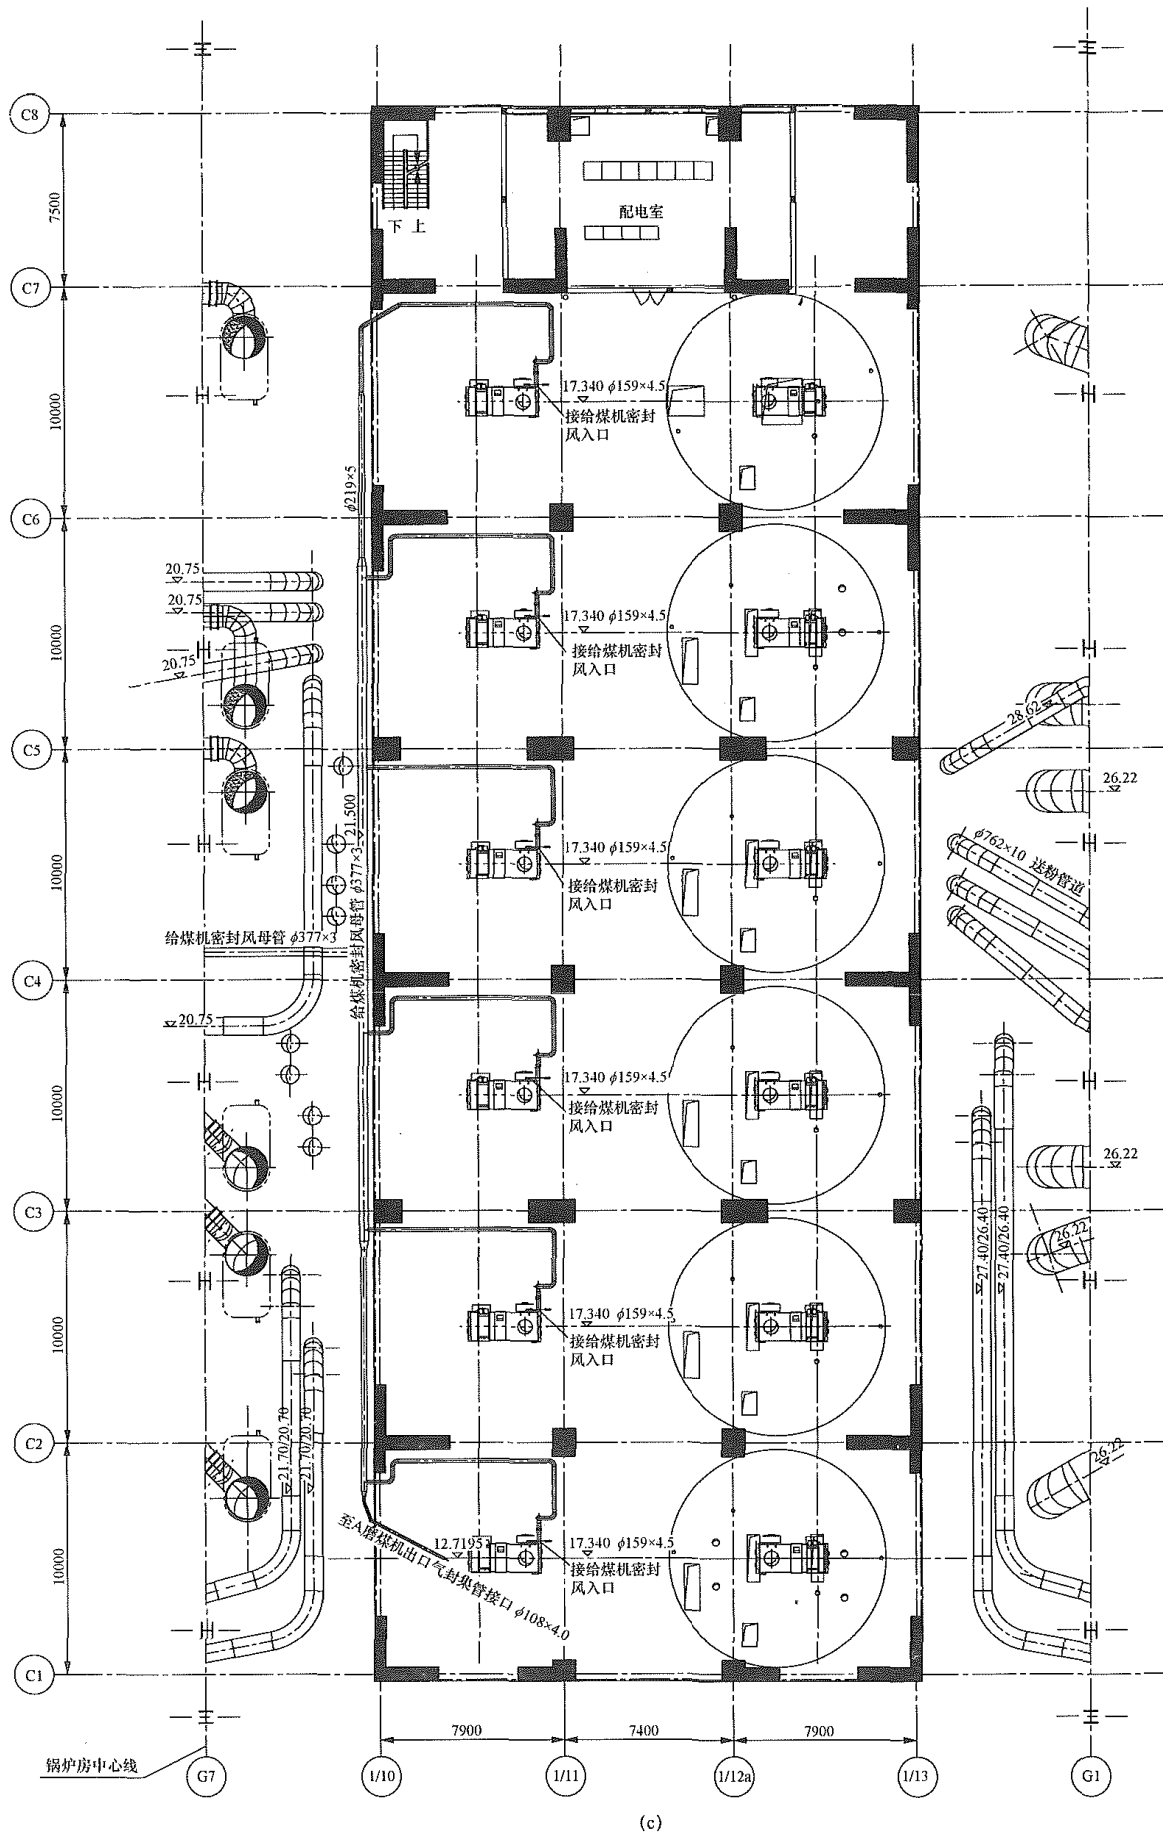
MPS 轮式磨煤机侧煤仓方案平面布置示意图 (二)
